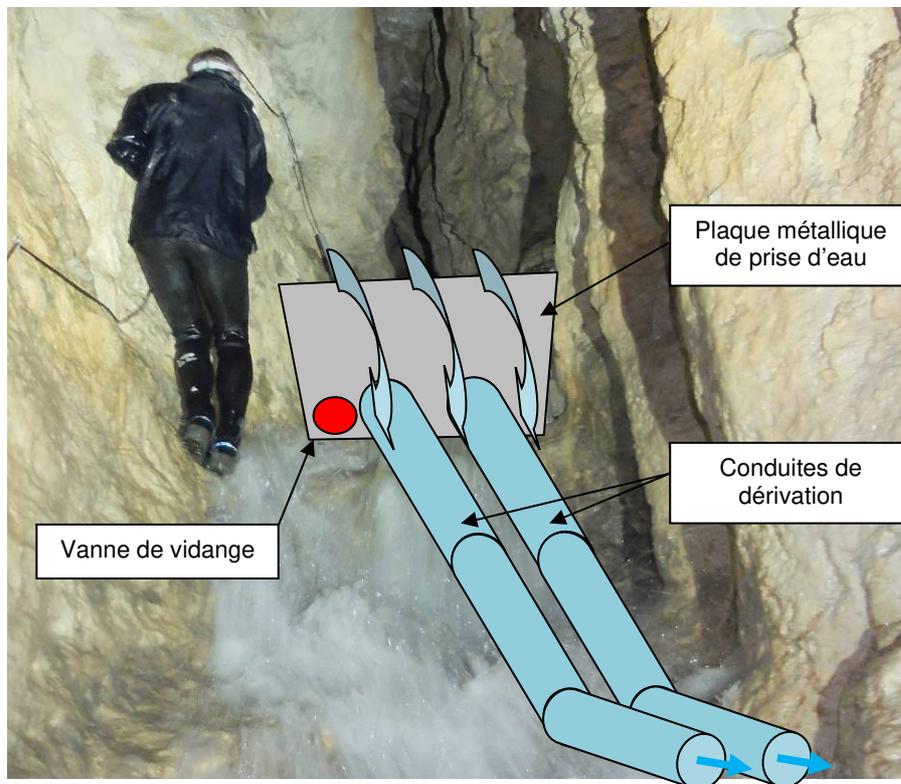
Photomontage de la prise d'eau projetée (avec 2 canalisations de 150 mm)
